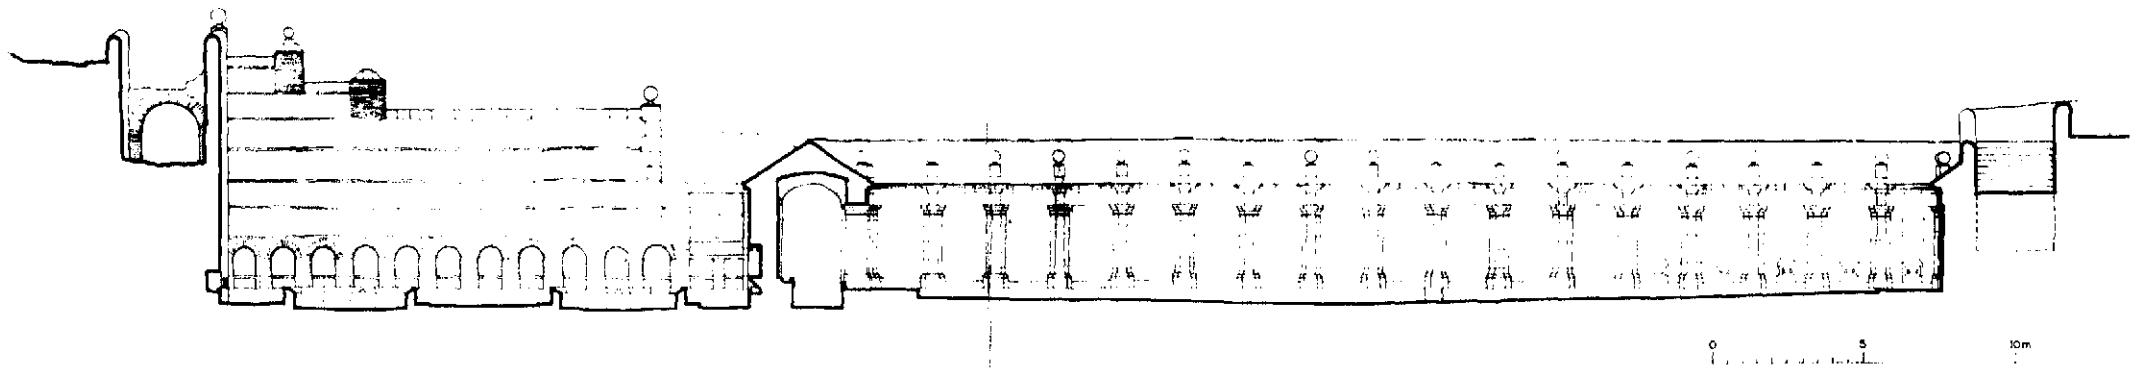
Alzado general del pórtico. E. 1 : 250
